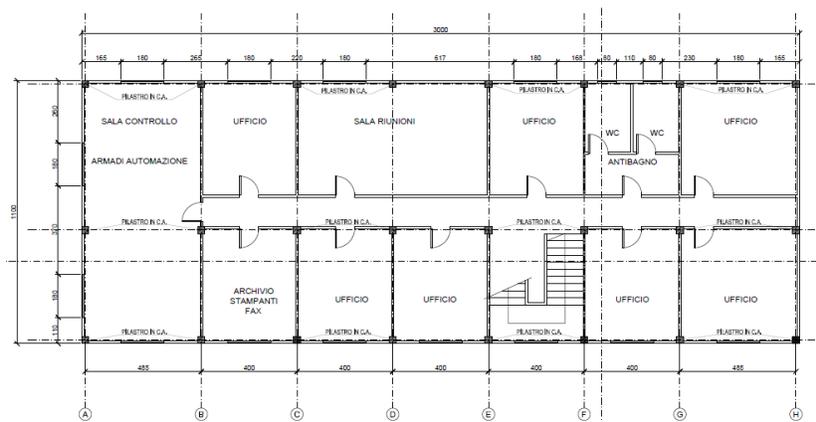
Edificio Uffici e Sala Controllo – Pianta (Primo Piano)
